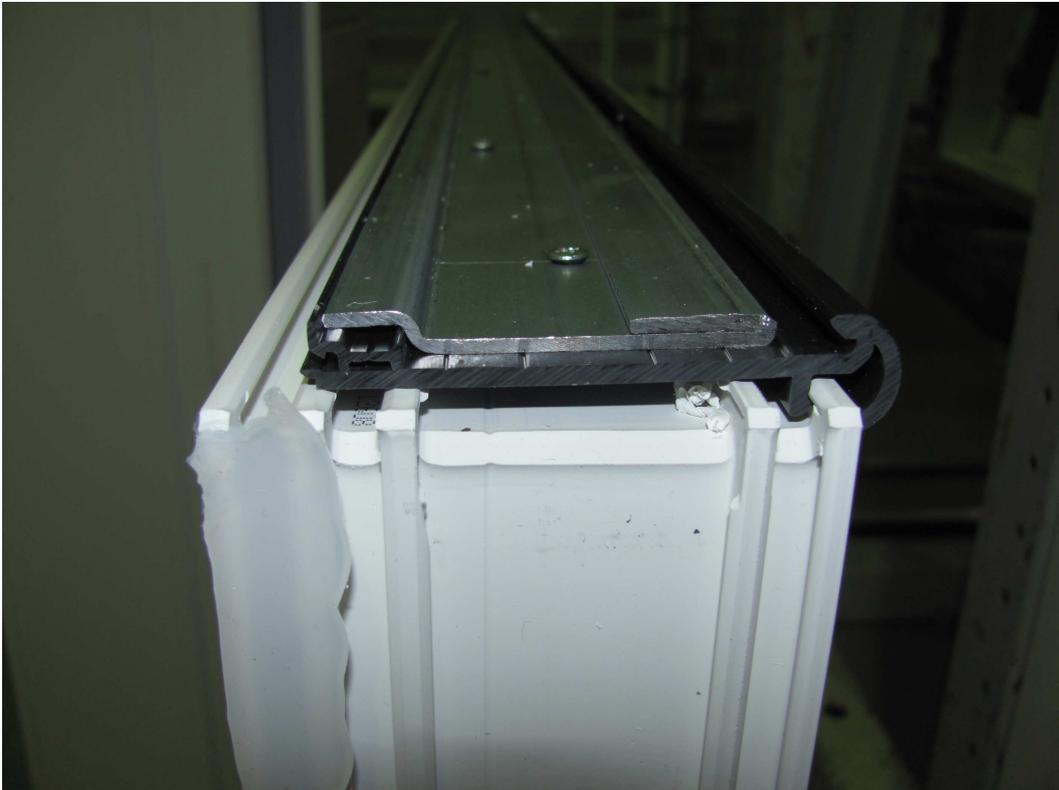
Basisprofil mit Blendrahmen geklippt und zusätzlich mit Stahlarmierung verschraubt
